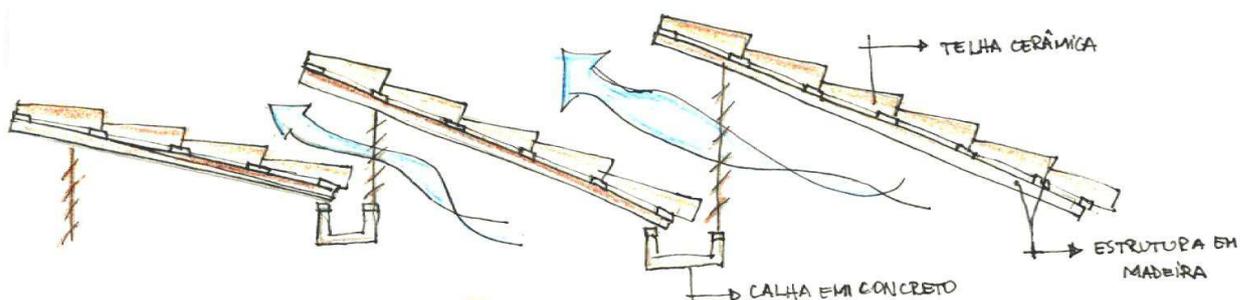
Croqui de shed em estrutura com madeira e fechamento em telha cerâmica.
